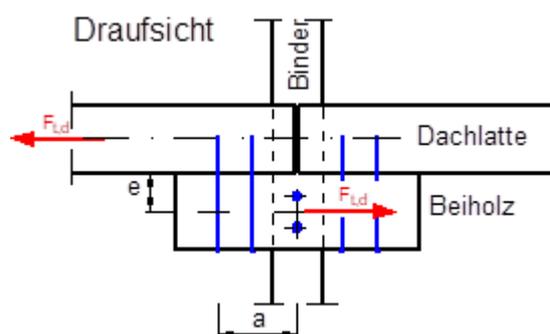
Definition der Abstände a und e sowie der Kräfte beim tragenden Stoß einer Dachlatte
